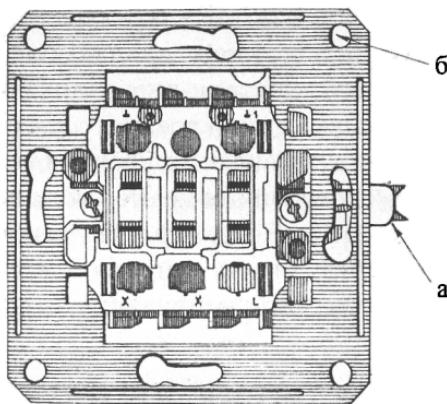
Схема металлической крепежной пластины: а — стандартная металлическая распорка (лапка); б — отверстия для крепления к монтажной коробке
